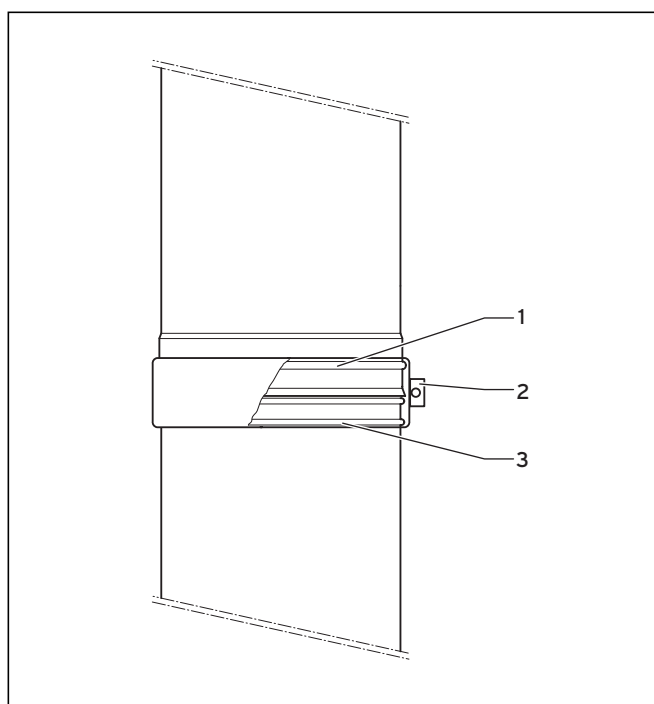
Крепление элементов наружной стены с помощью хомута воздуховода
